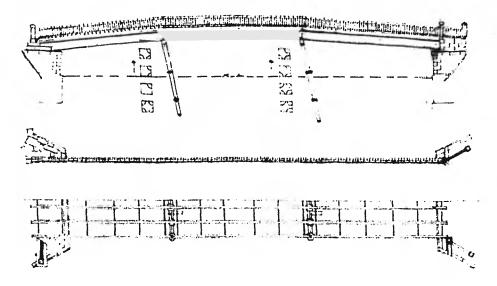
DAROS AL PUENTE TSURUNO - BASHI
